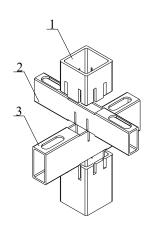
开孔矩形钢管混凝土组合梁示意图
